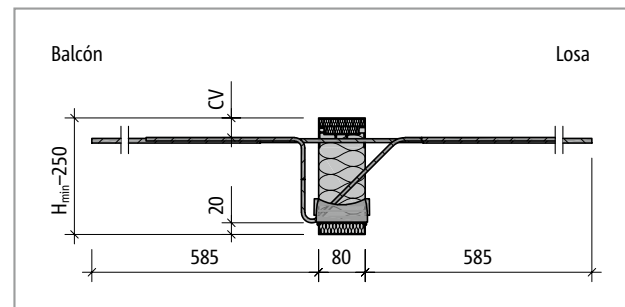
Schöck Isokorb® T tipo K-M5 y K-M6: Sección del producto
